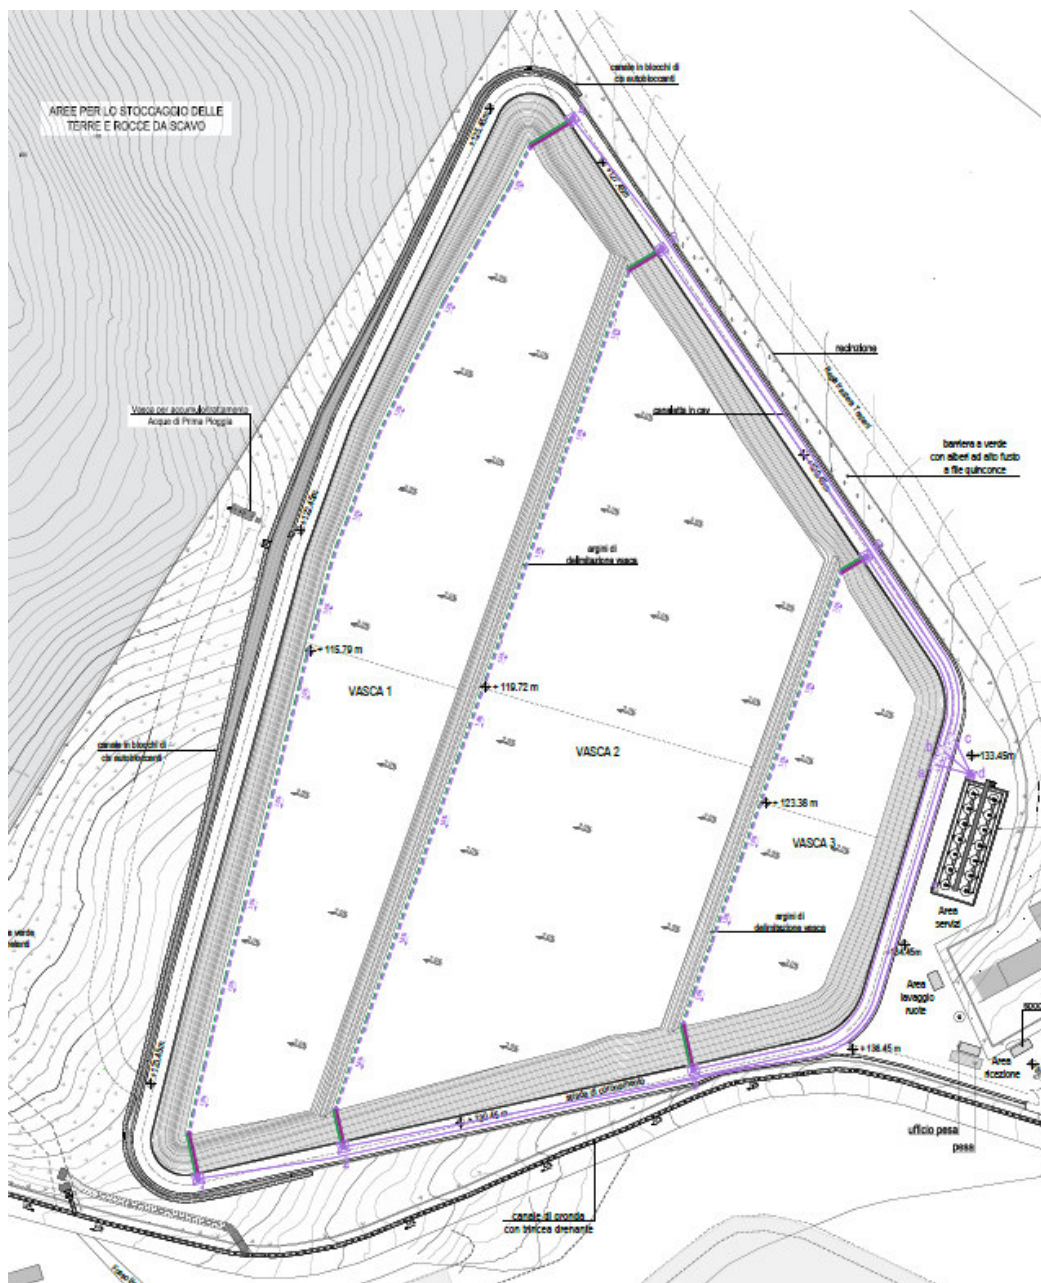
PLANIMETRIA RETI DI DRENAGGIO
